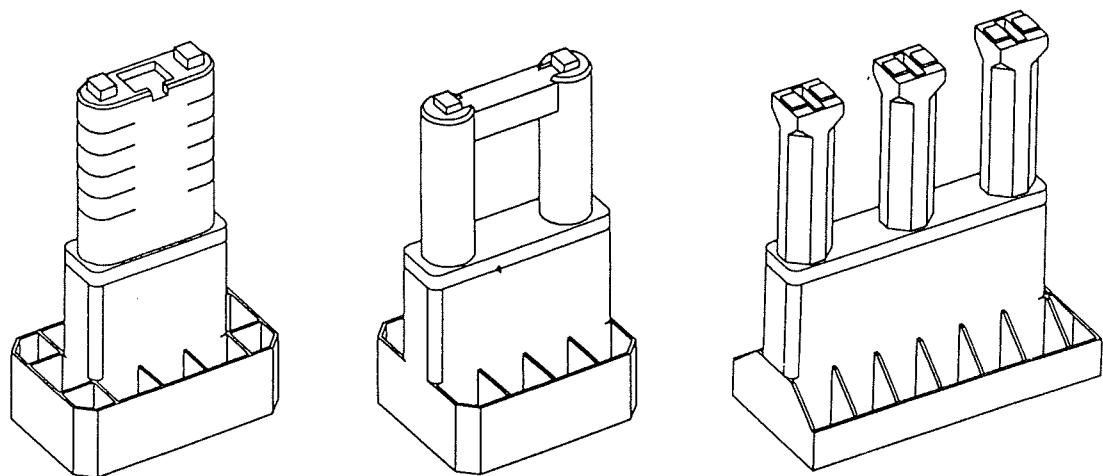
Diseño durable para pilas de puentes. Proyecto de oferta del Puente del Oeste, Enlace del Gran Belt, Dinamarca. Ver sección 7.
